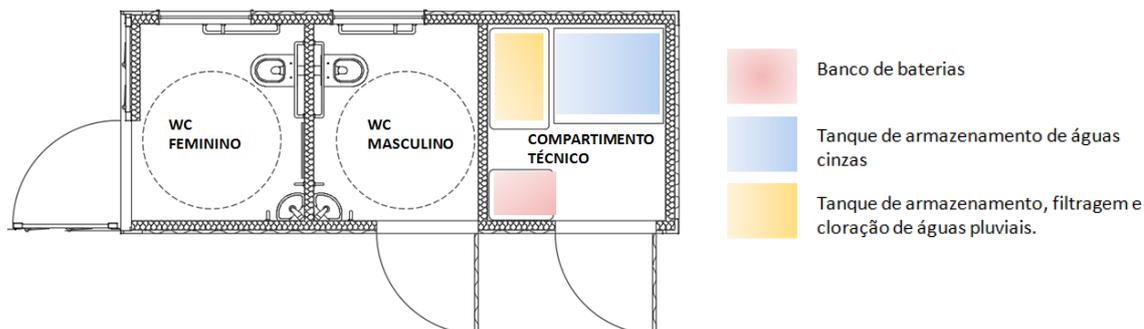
Planta Baixa Módulo 03 - Acessível. Fonte: elaborado pelos autores.
